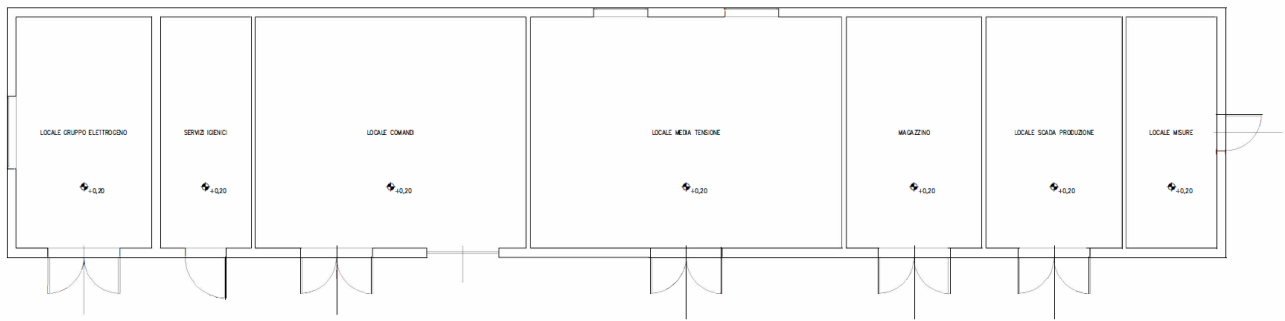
Architettonico fabbricato Cabina Utente 150/30 kV – Pianta
